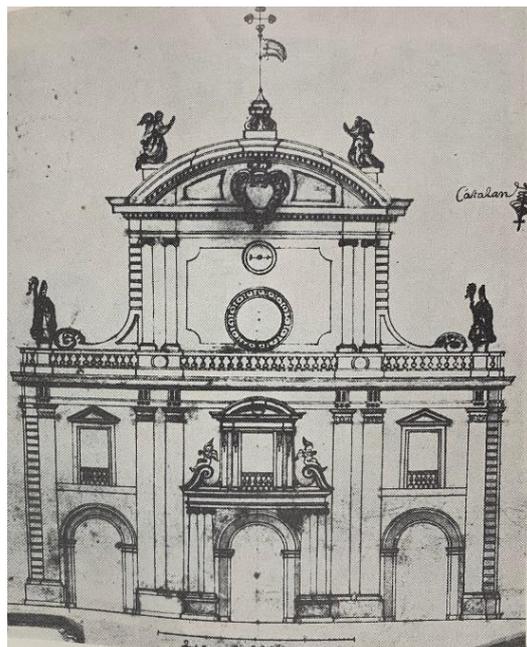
Juan L. Catalán. Proyecto de fachada 1759-60.
